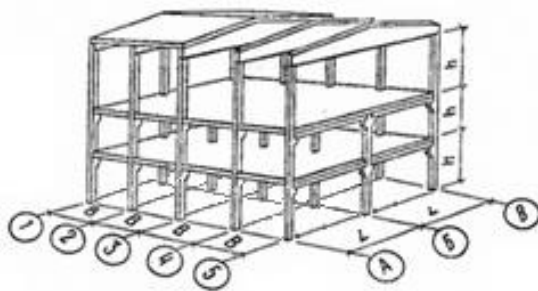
Схема каркасної багатоповерхової будівлі з верхнім поверхом зального типу
